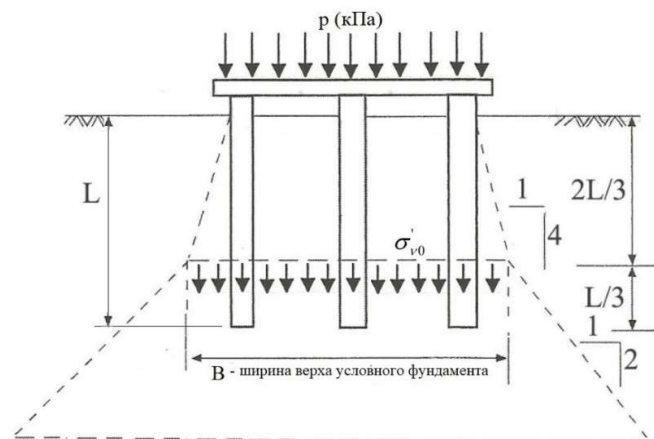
Расчетная схема для определения подошвы условного фундамента
